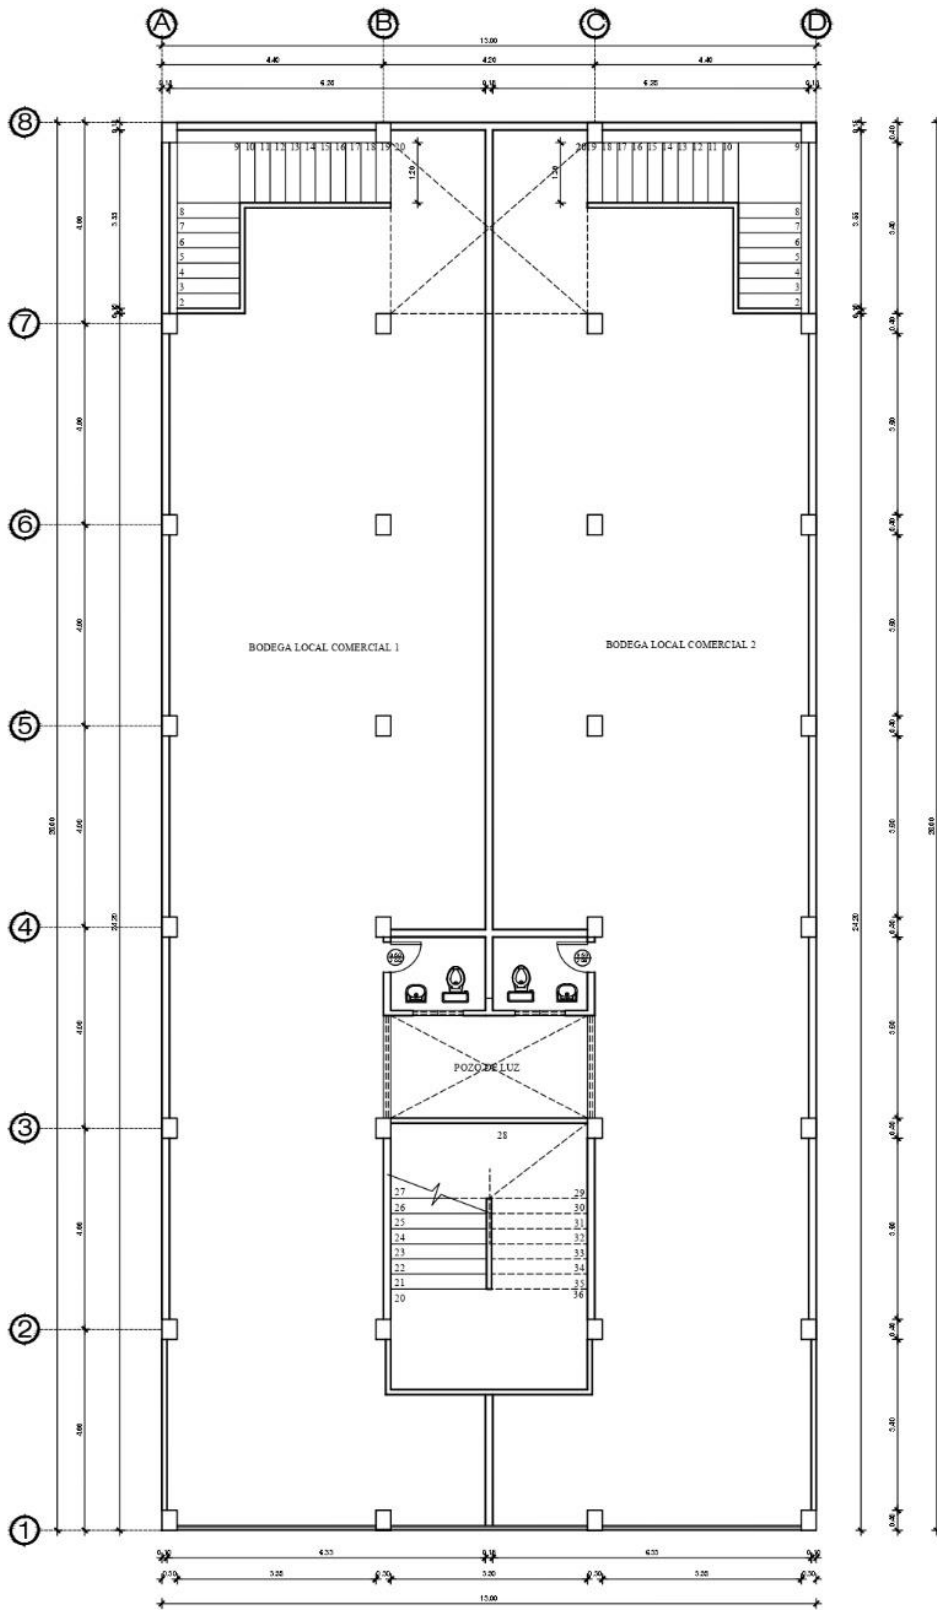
Planta arquitectónica bodega (Autores)
